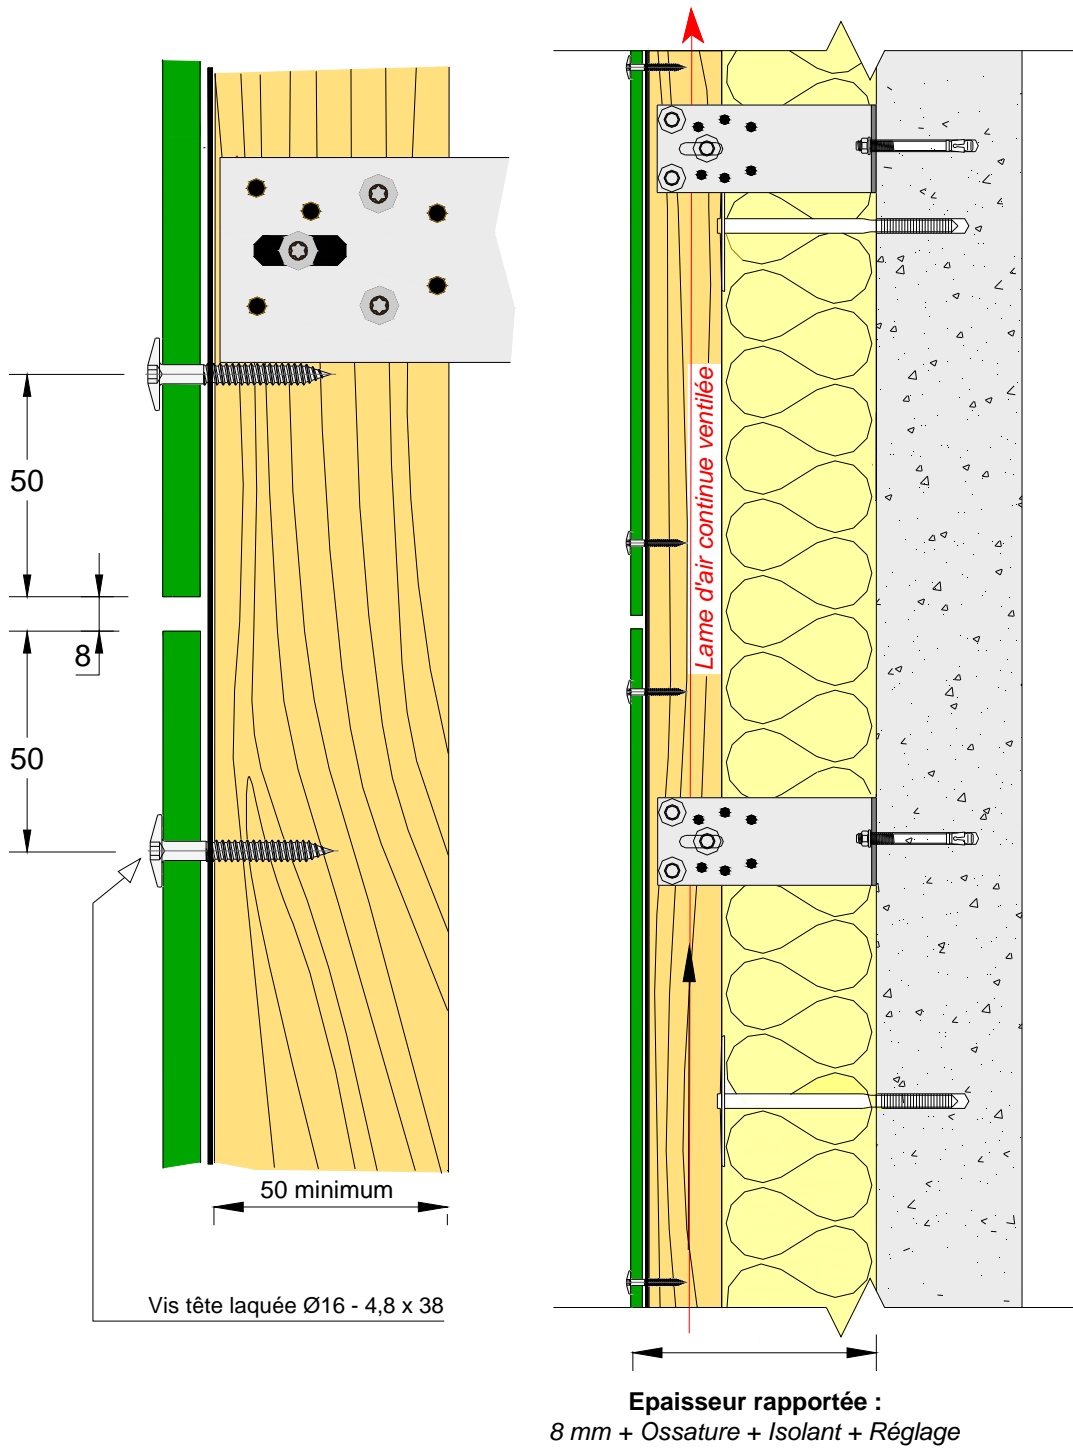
Coupe verticale sur joint horizontal ouvert
